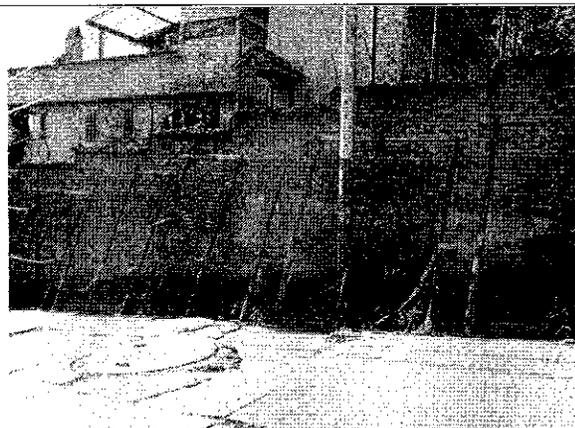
Vista general del muro objeto de la visita, se observa el apuntalamiento temporal en madera.
